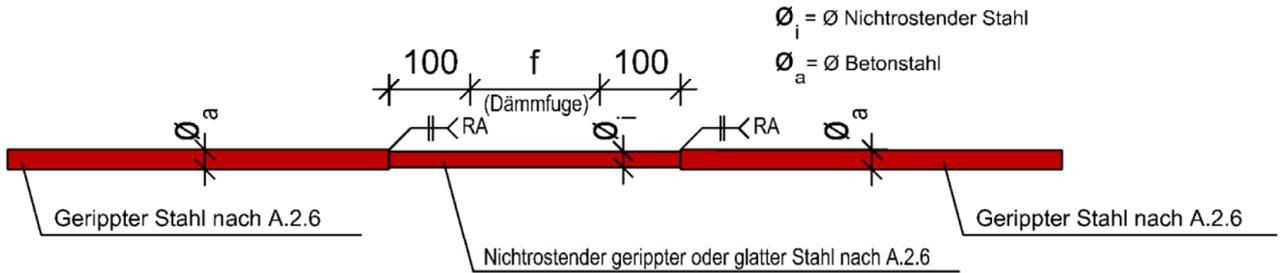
Druckstabvariante 2 – stumpfgeschweißt
